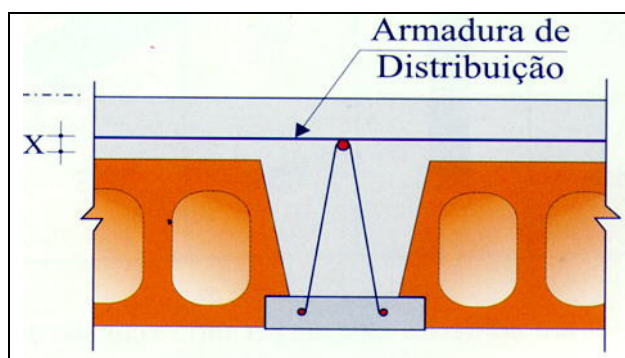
Laje pré-fabricada do tipo treliçada (FAULIM, 1998).
